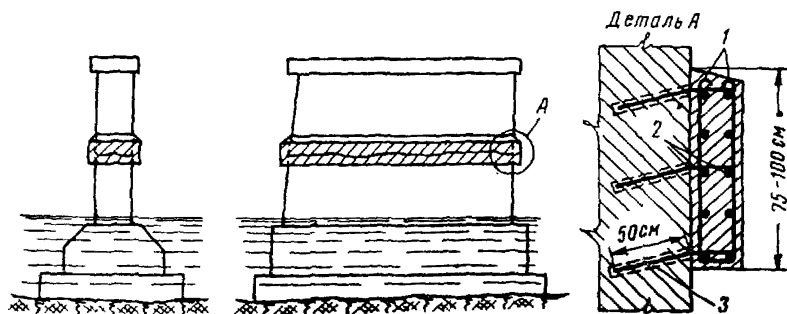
Усиление опоры железобетонным поясом: 1 — арматурные стержни 19 мм; 2 — распределительная арматура диаметром 8 мм; 3 — анкер из арматурного железа диаметром 20 мм
